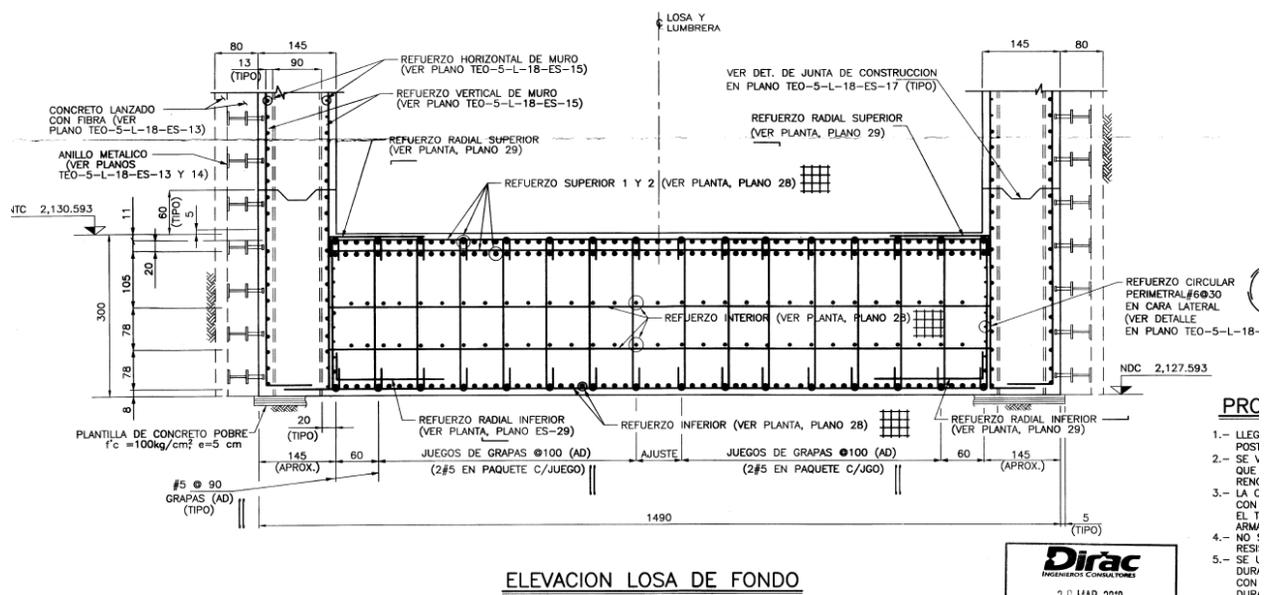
56 Diagrama de armado de acero en losa de fondo
